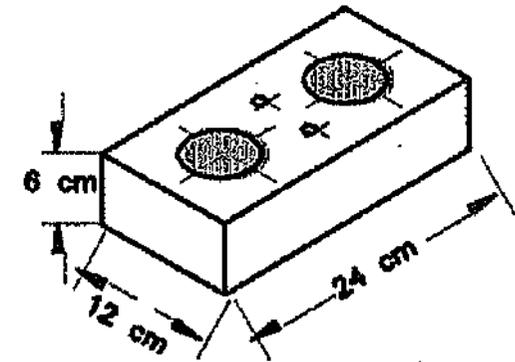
Detalle block hueco, fuente Detalles de Arquitectura, Miguel Murguía Díaz.
